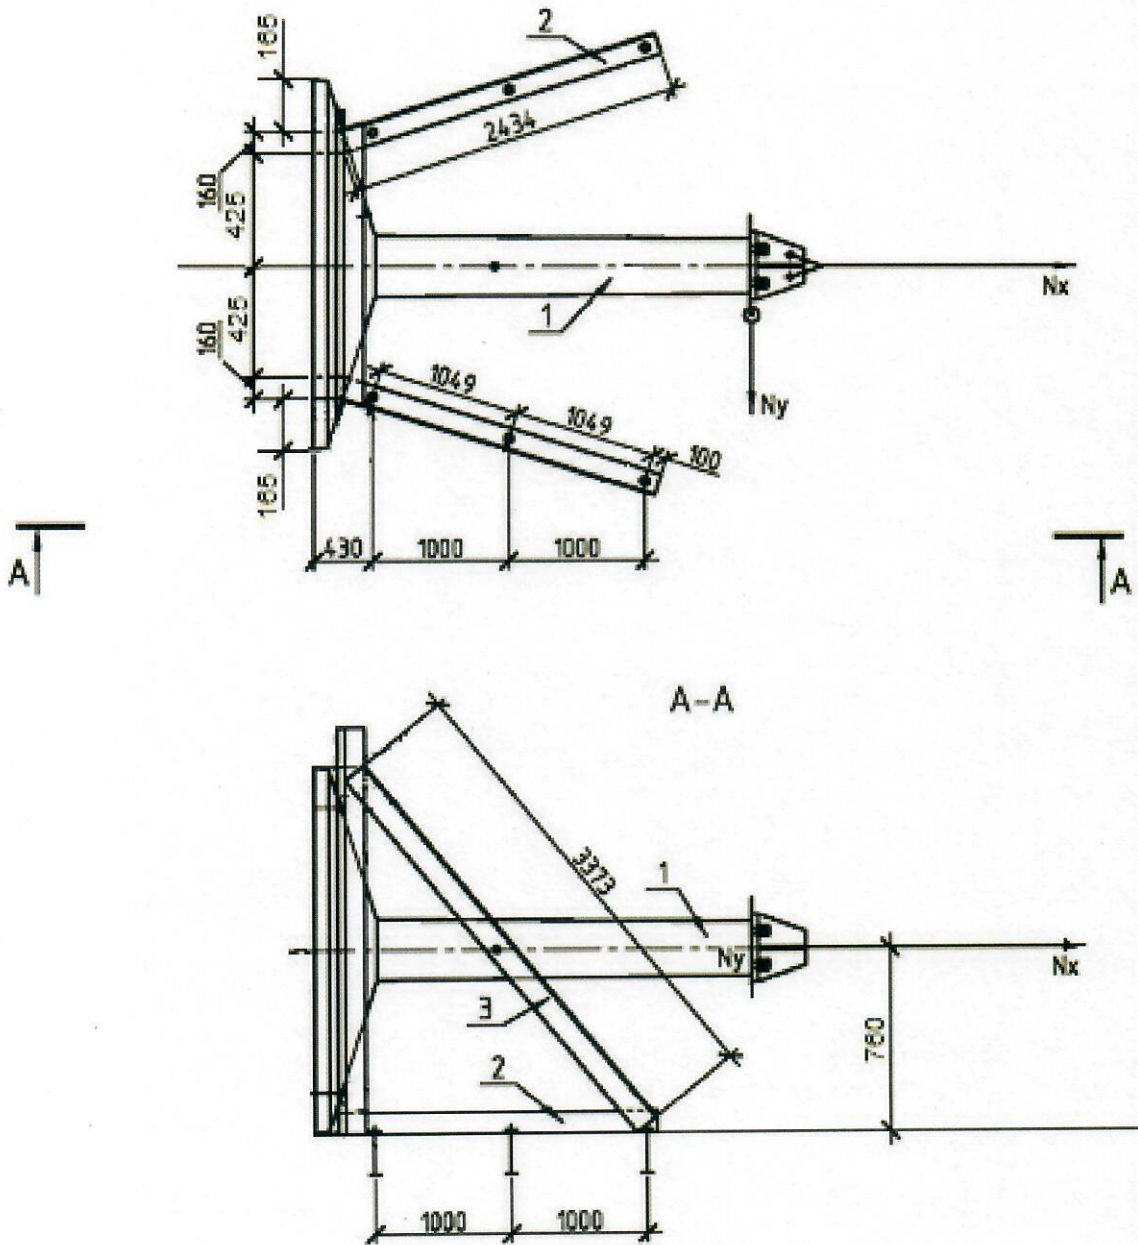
Расчетная схема испытания фундамента Ф2-2
